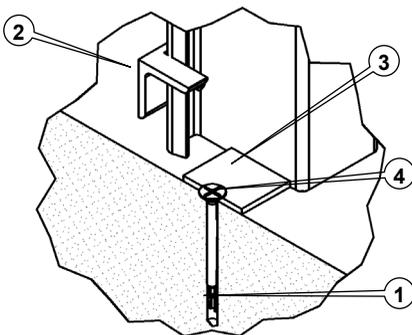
Befestigung der Zarge mit Befestigungsplatte
